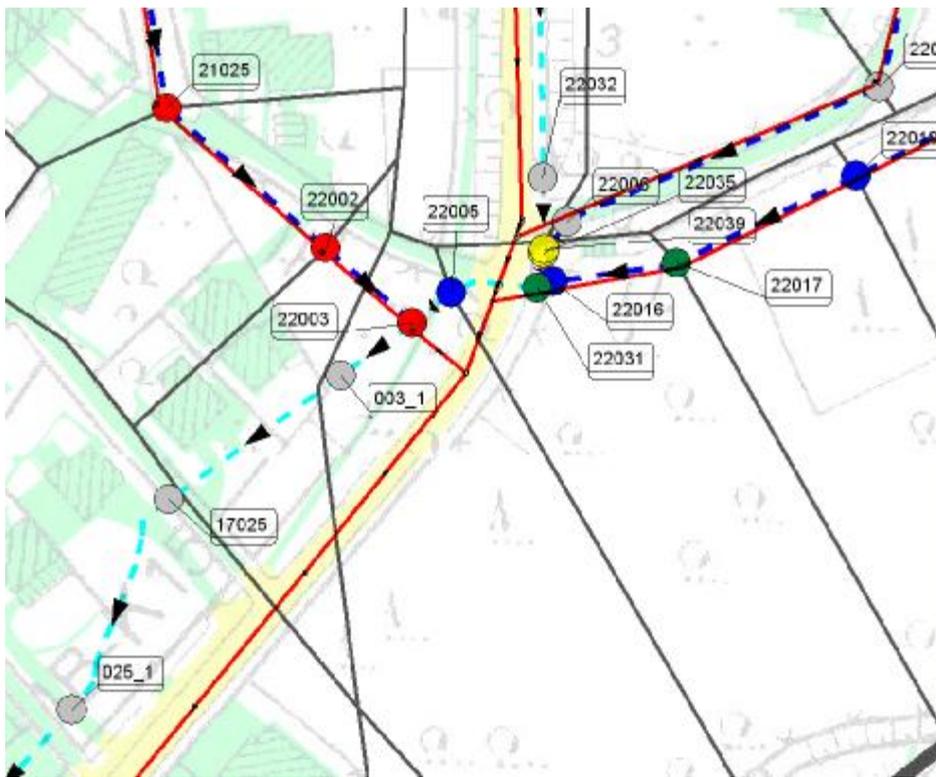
Lageplan des betrachteten Kanalnetzes mit Angabe der Schachtnummern
